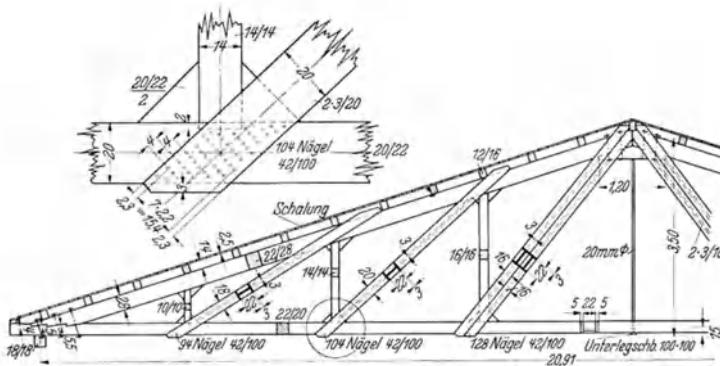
Binder über der Feierabendhalle der Stadt Holzminden.
